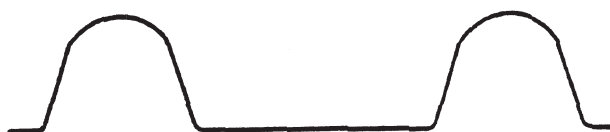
Querschnitt eines typischen Trapezprofils mit gerundetem Obergurt
